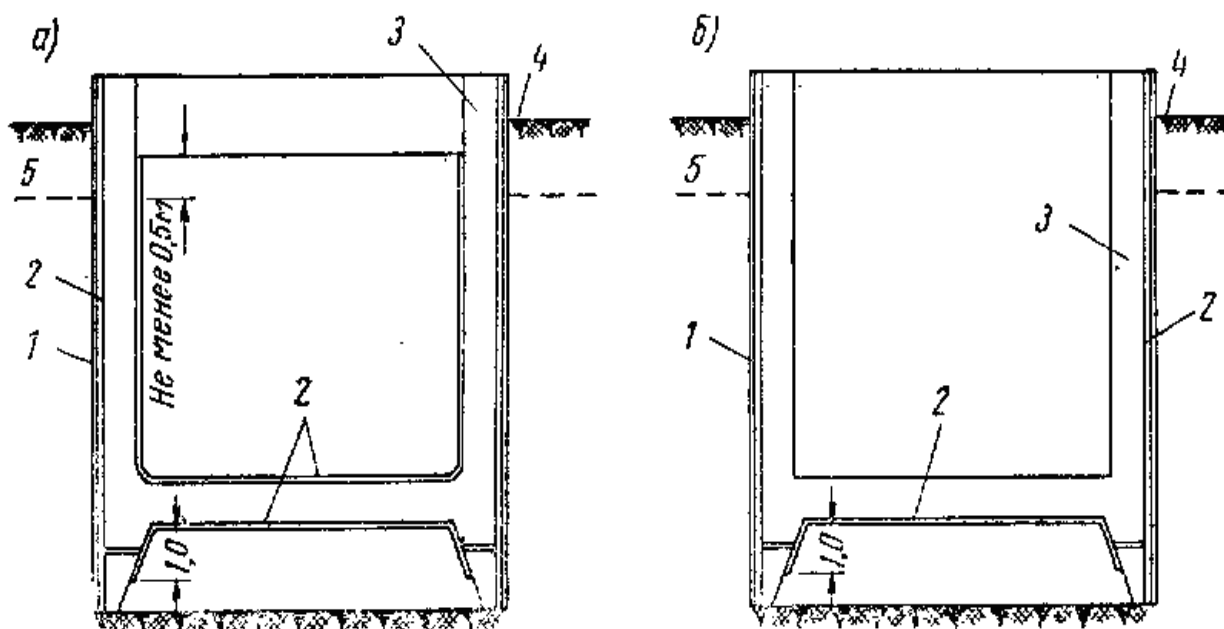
Гидроизоляция кессонов: а – с двух сторон; б – с одной наружной стороны; 1 – окрасочная битумная гидроизоляция; 2 – цементная гидроизоляция; 3 – несущая конструкция; 4 – уровень земли; 5 – максимальный уровень грунтовых вод
